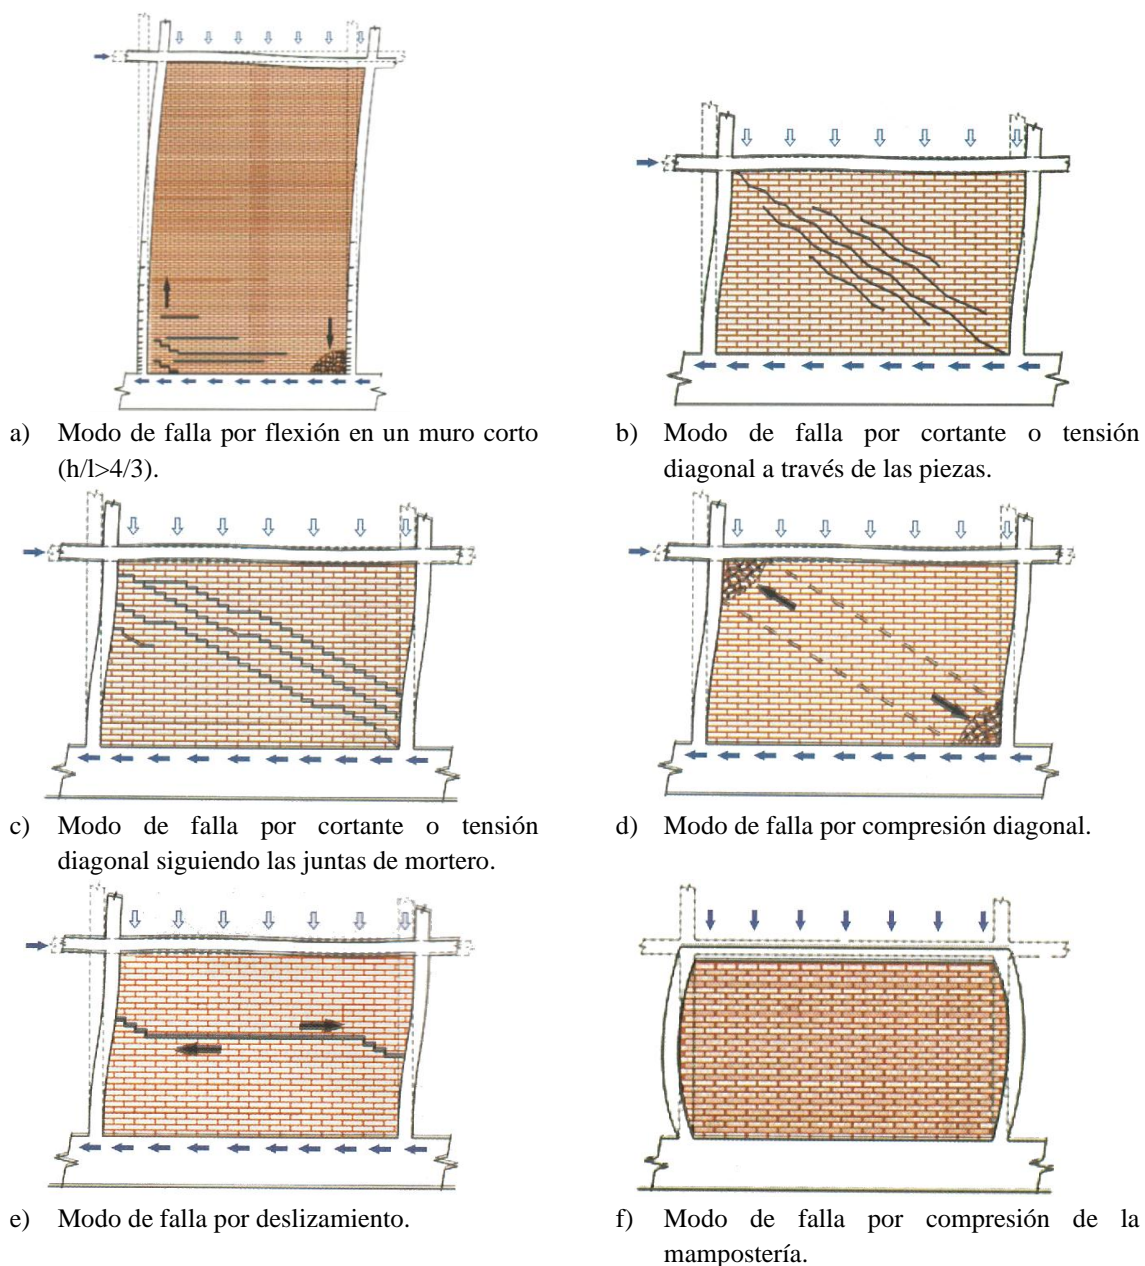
Modos de falla característicos en muros de mampostería confinada [1].
